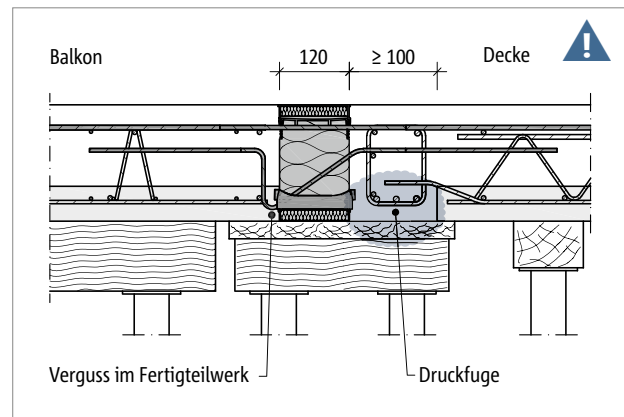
Schöck Isokorb® XT Typ KL-F: Druckfuge deckenseitig in Verbindung mit Halffertigteilplatten; indirekte Lagerung
